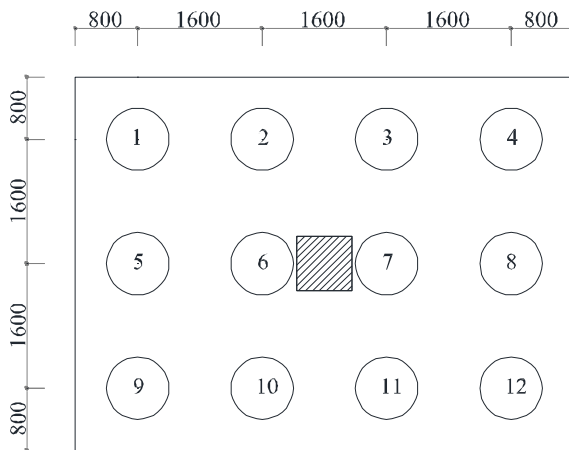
Pondasi Tiang Pancang Tipe 1
